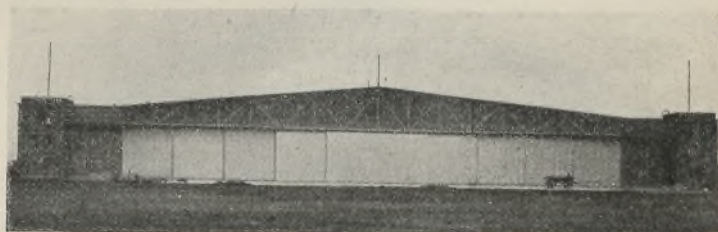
Flugzeughalle Hamburg-Fuhlsbüttel. (Ausführung Spaeter, Hamburg.)
